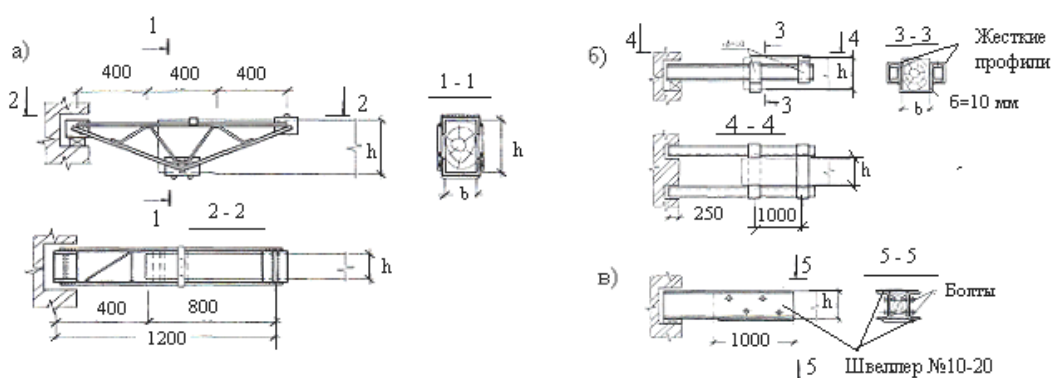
Усиление опорных концов деревянных балок с помощью металлических протезов:
